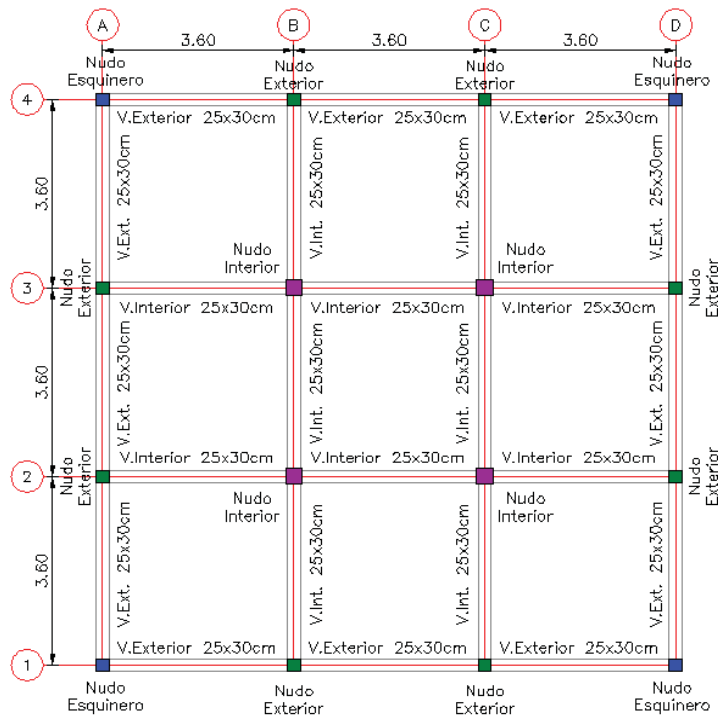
Geometría en planta pisos 1,2,3 (Ejemplo de aplicación)
